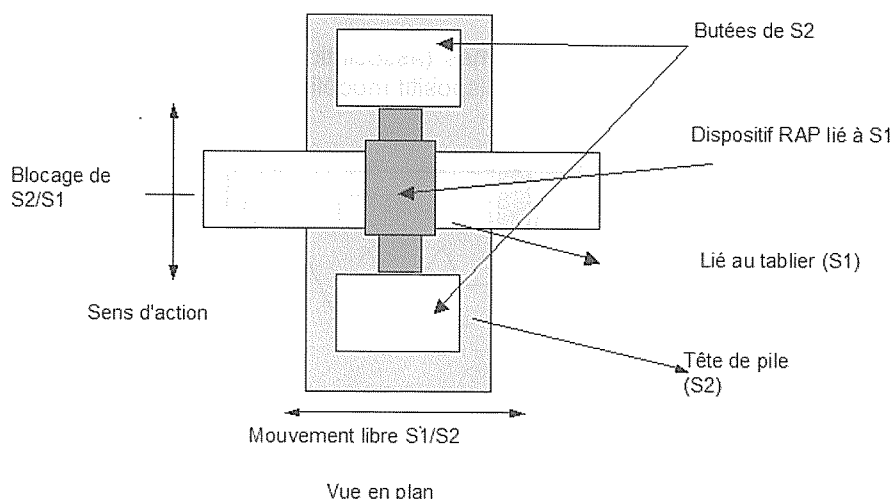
Exemple d'installation d'un RAP entre 2 structures S1 et S2
